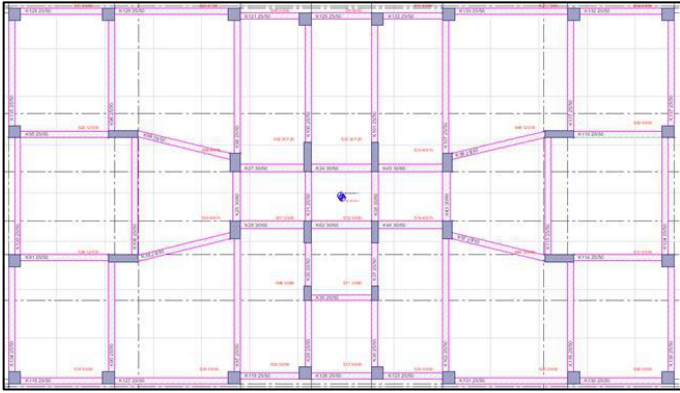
Yapıdaki tüm betonarme perdelerin kaldırılarak bodrum perdesi kullanımı ile oluşturulan P4 planı
